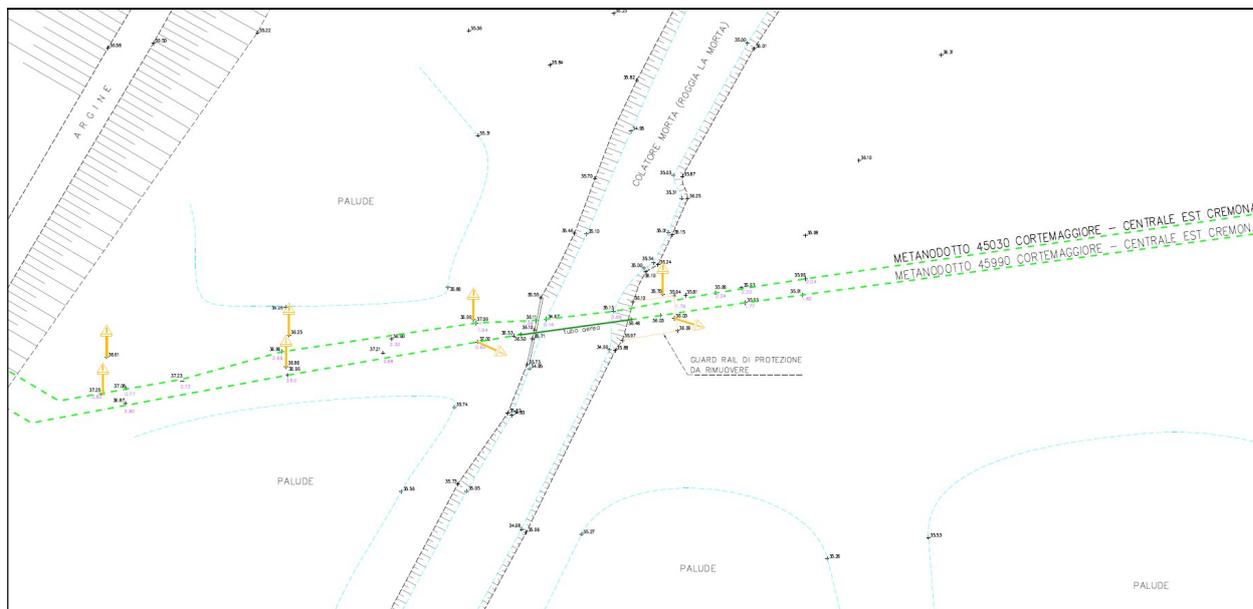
Stralcio celerimetrico della zona in esame con indicazione dell'attraversamento aereo sulla Roggia La Morta, da recuperare.
